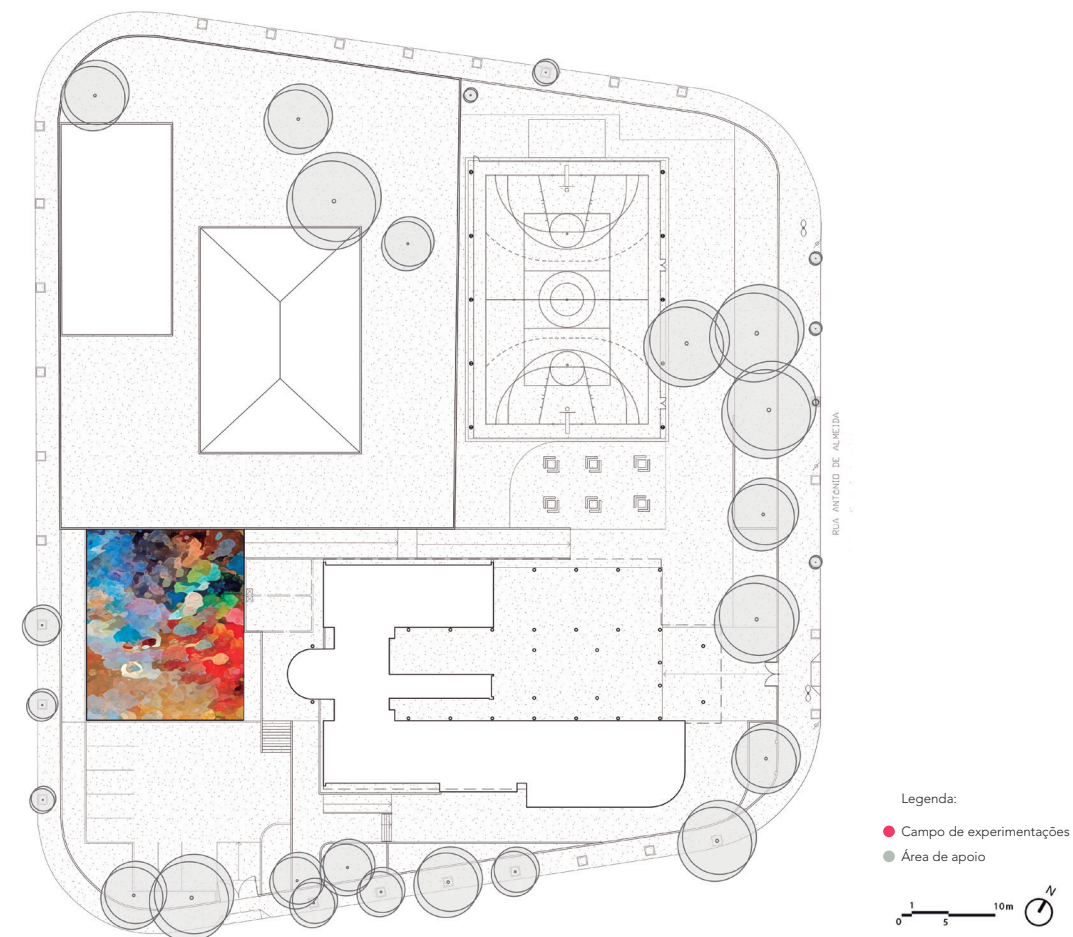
Planta baixa da área principal de intervenção: o Campo de experimentações.
